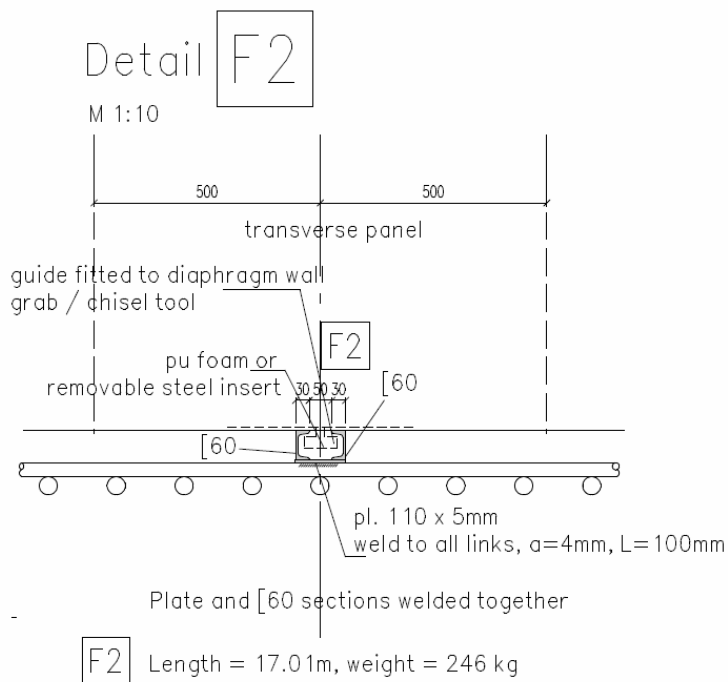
Innstøpt guide for rengjøring mot tverrpaneler:
